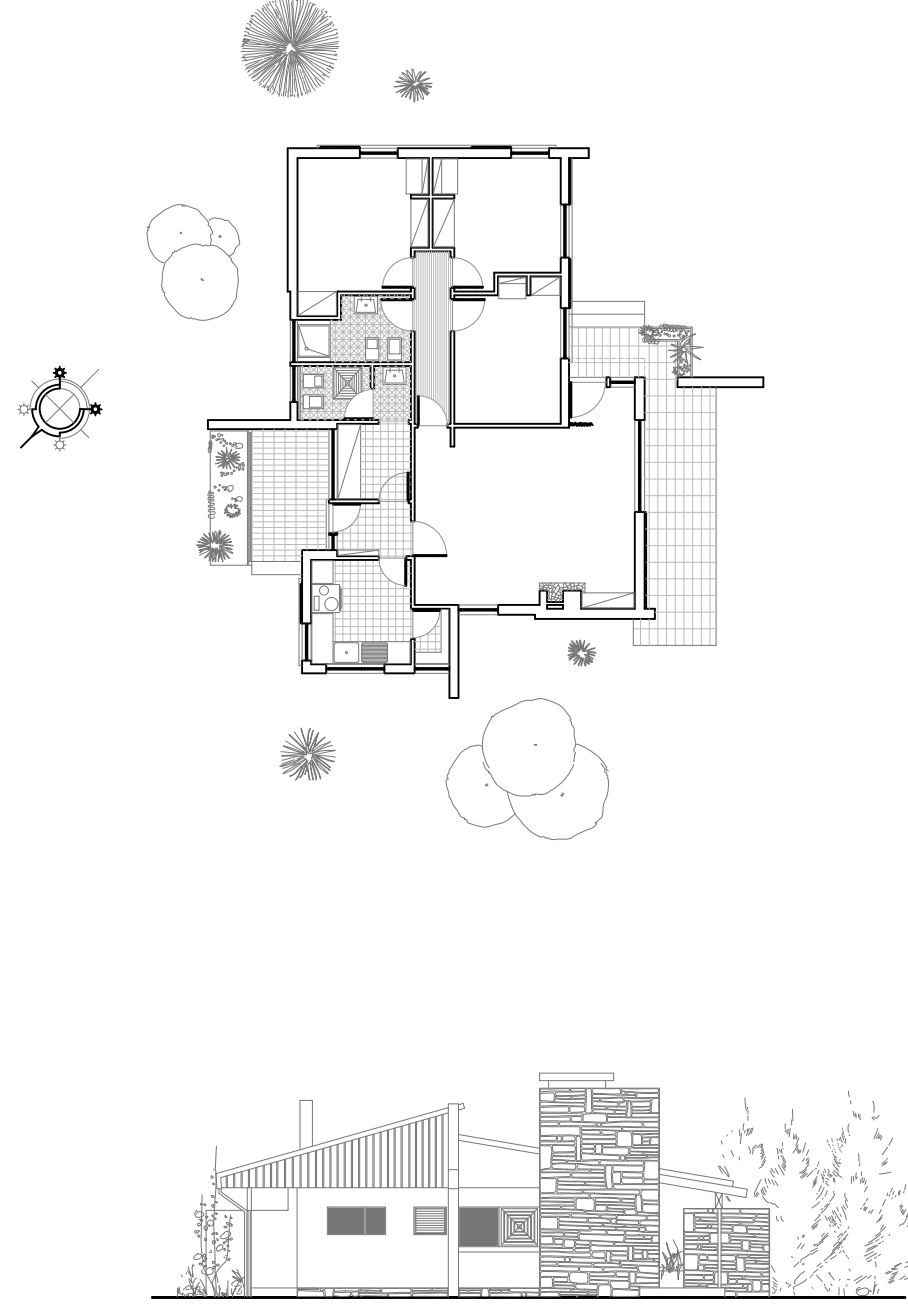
Planta e alçado noroeste da Casa Santos Silva - escala 1.200.
